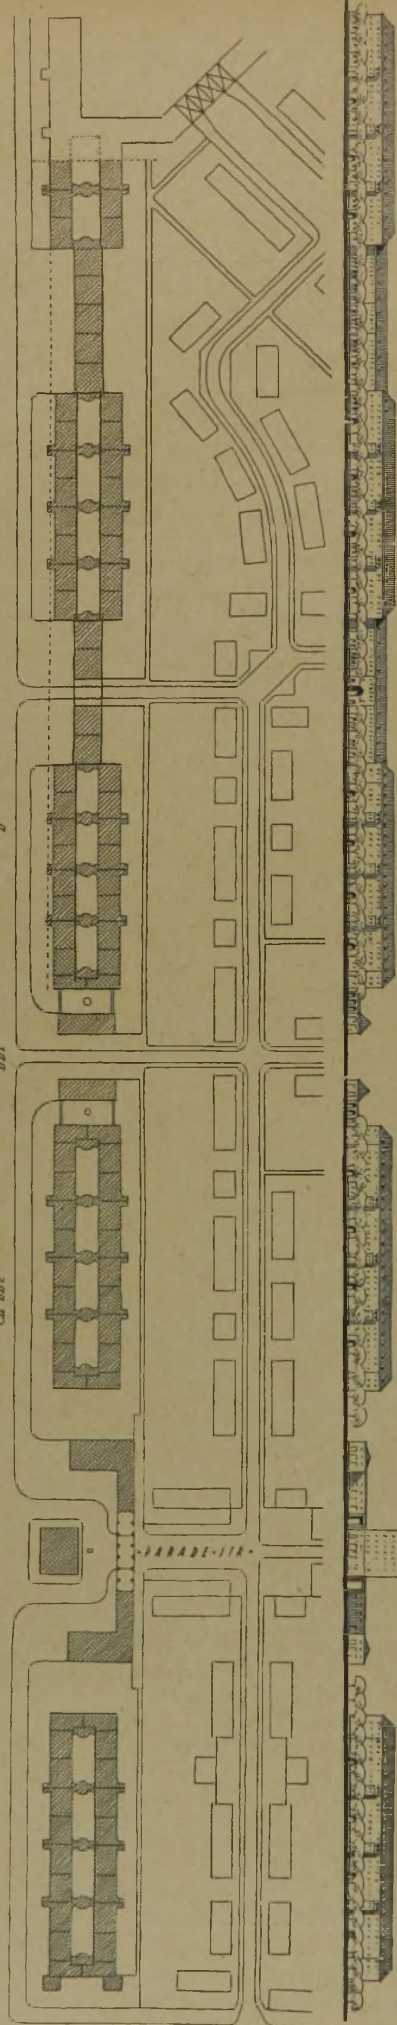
Ein Preis von 5000 M. Verfasser: Arch. Otto Rudolf Salvisberg, Berlin-Studende. Lageplan. Maßstab 1 : 4000.
